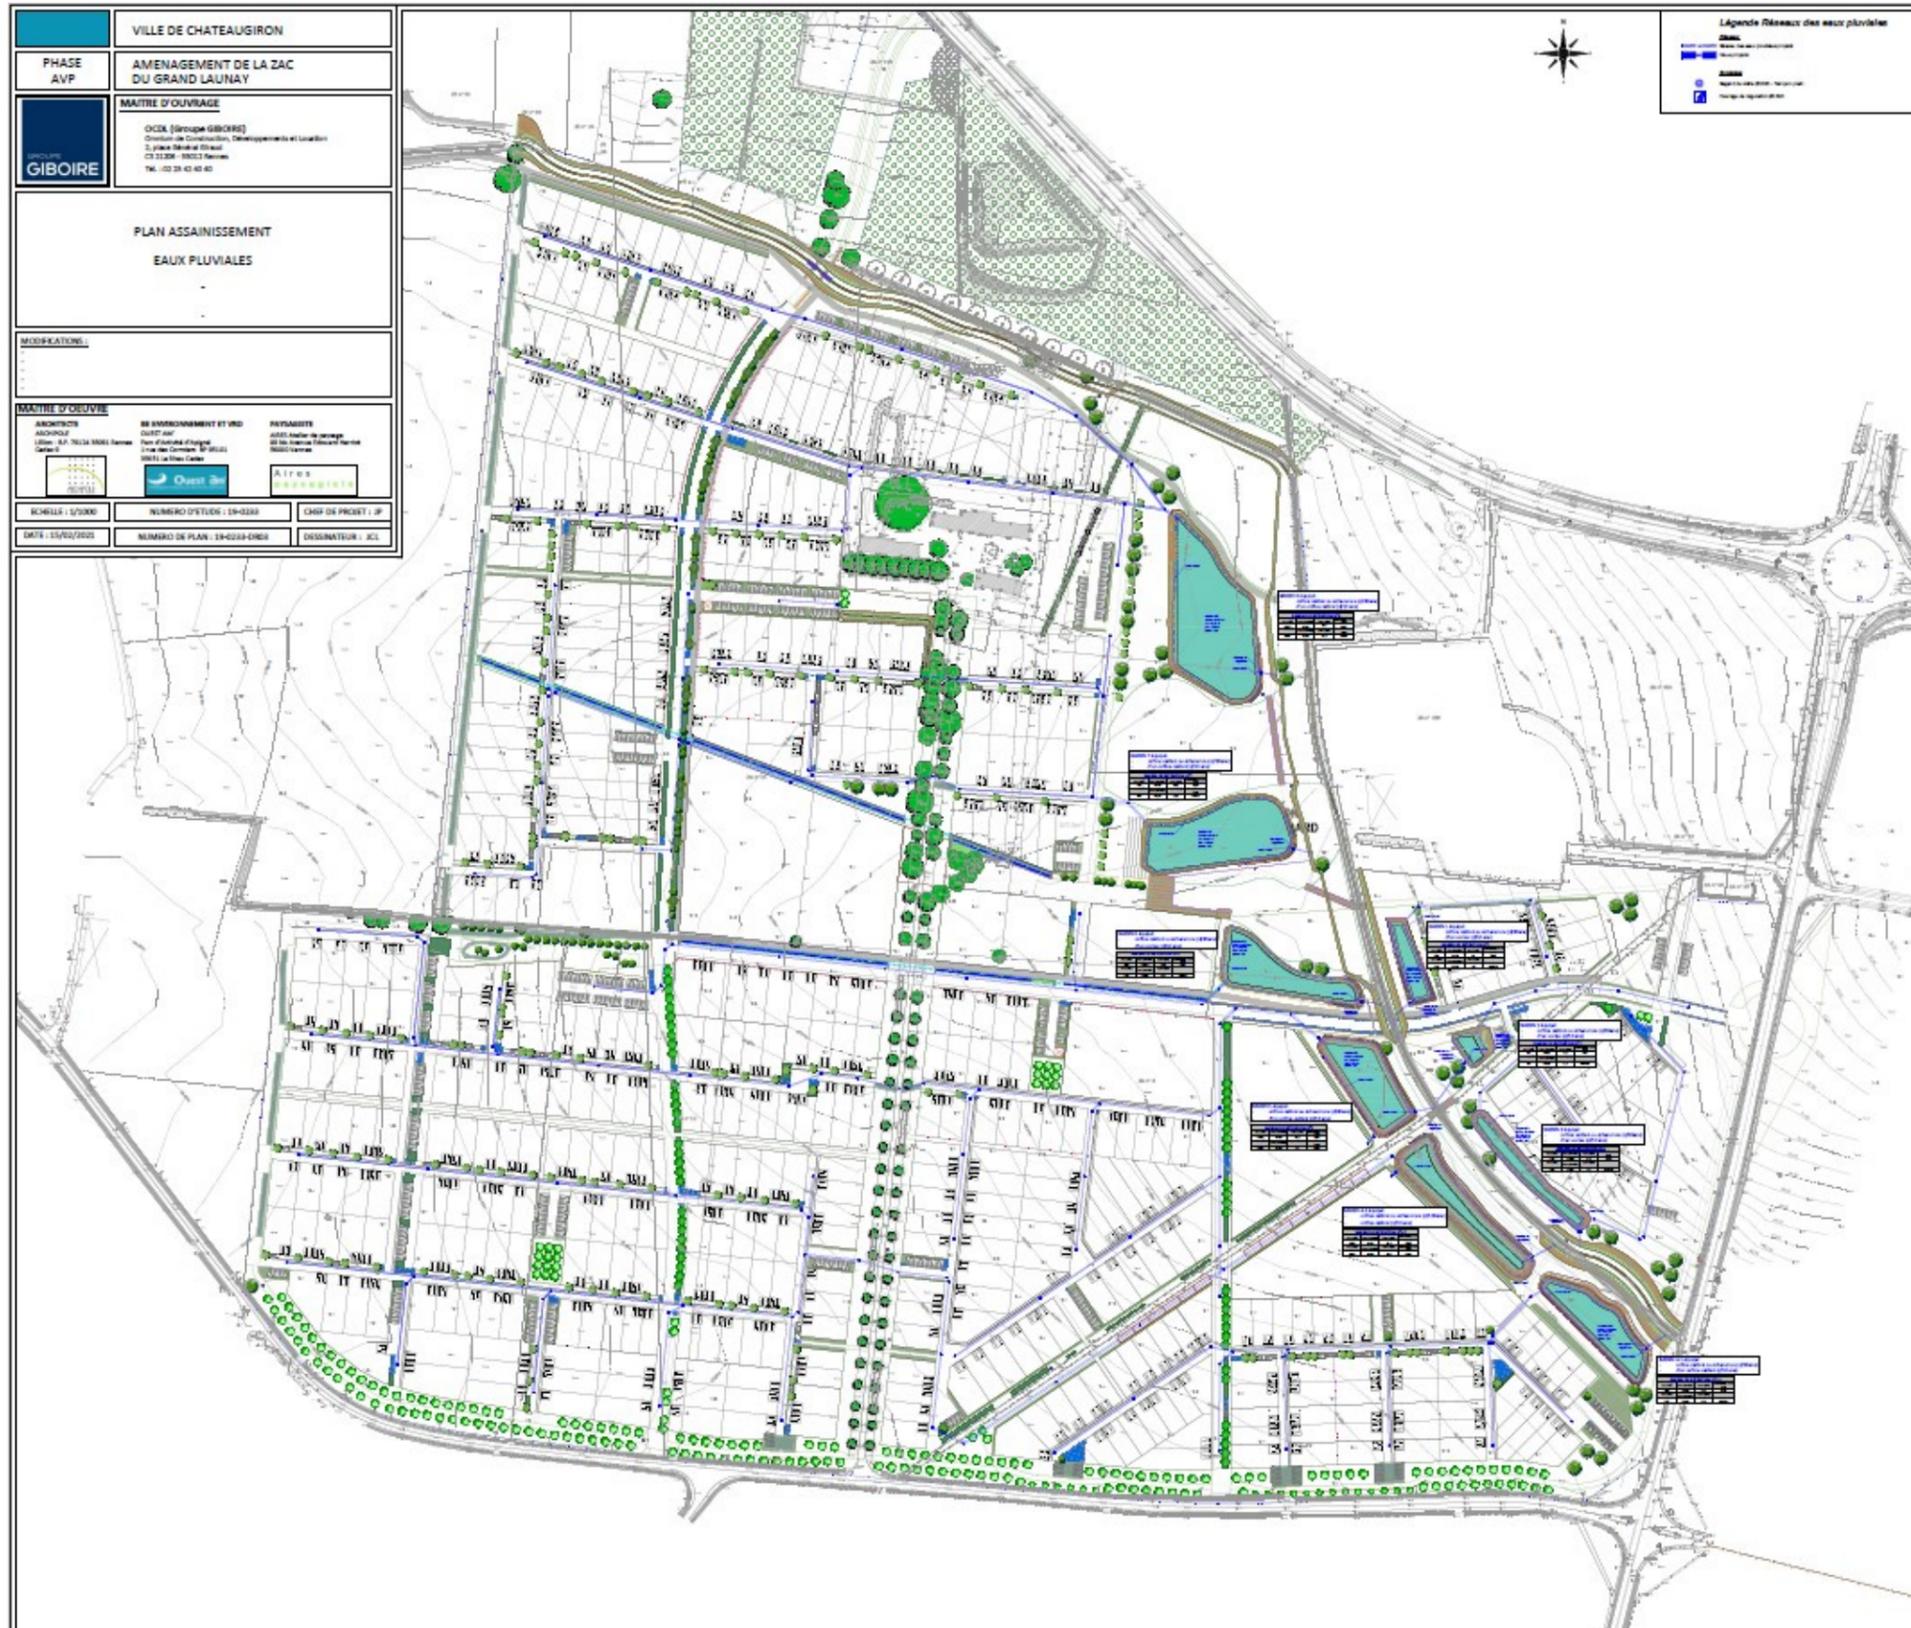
Plan du réseau pluvial (voir plan A0 joint au dossier)
